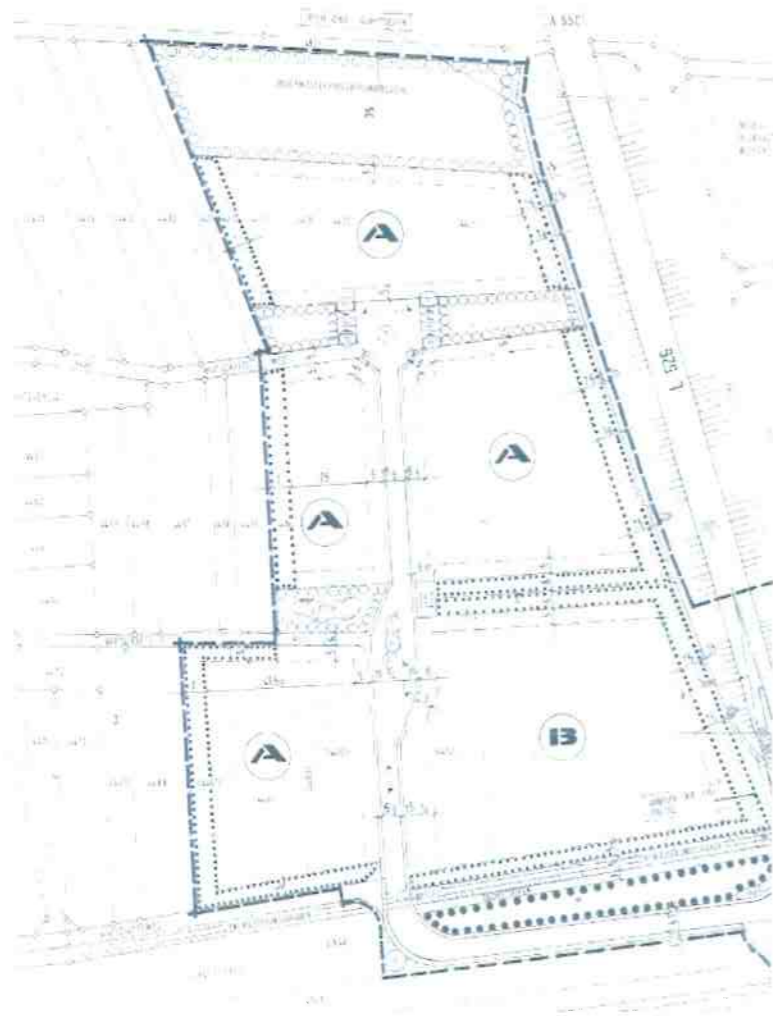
alter Bebauungsplan des Gewerbegebietes "Nauroth"
